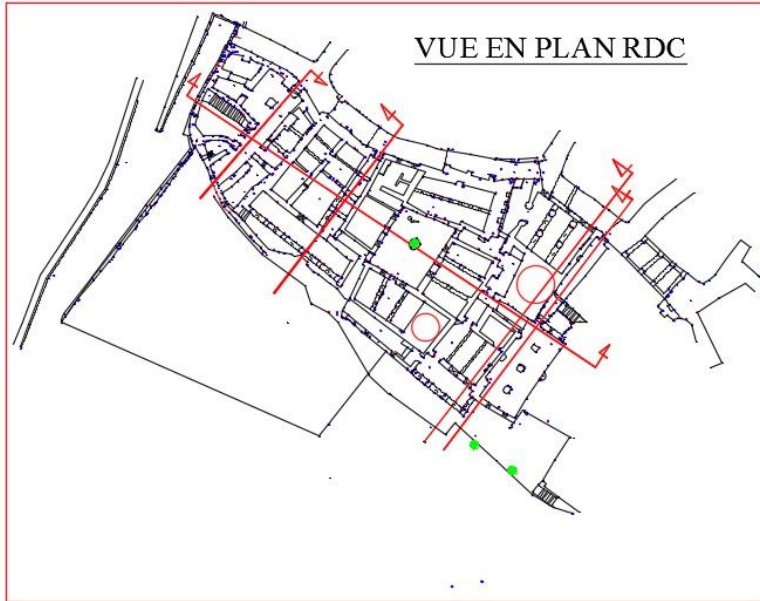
(Plan RDC de la Zawya Tidjania à Boussemgoune)
